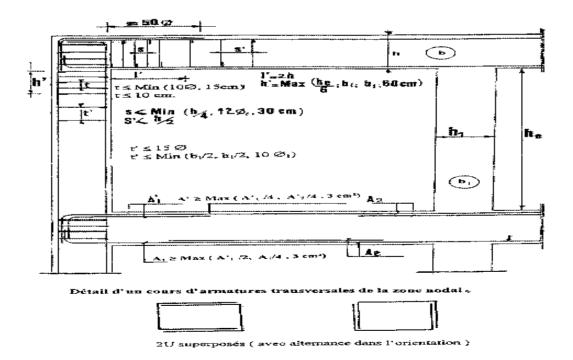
Disposition constructives pour les poutres selon R.P.A99/03
